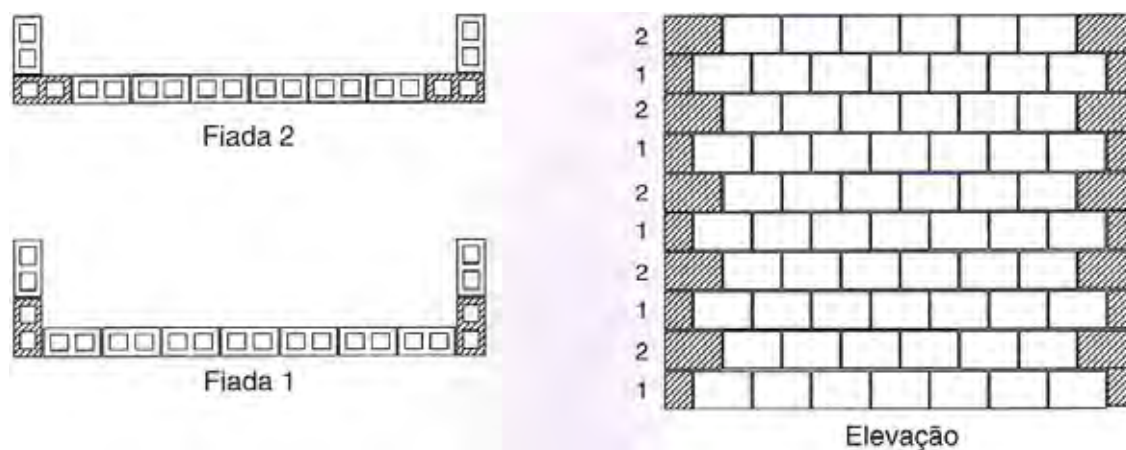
Detalhe da primeira e segunda fiadas e elevação da parede
